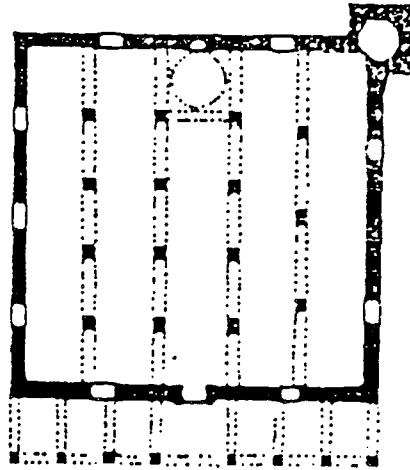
Malatya, Ulu Camii. Eyvanın ve kubbeli kısmın planı (Gabriel'den)
